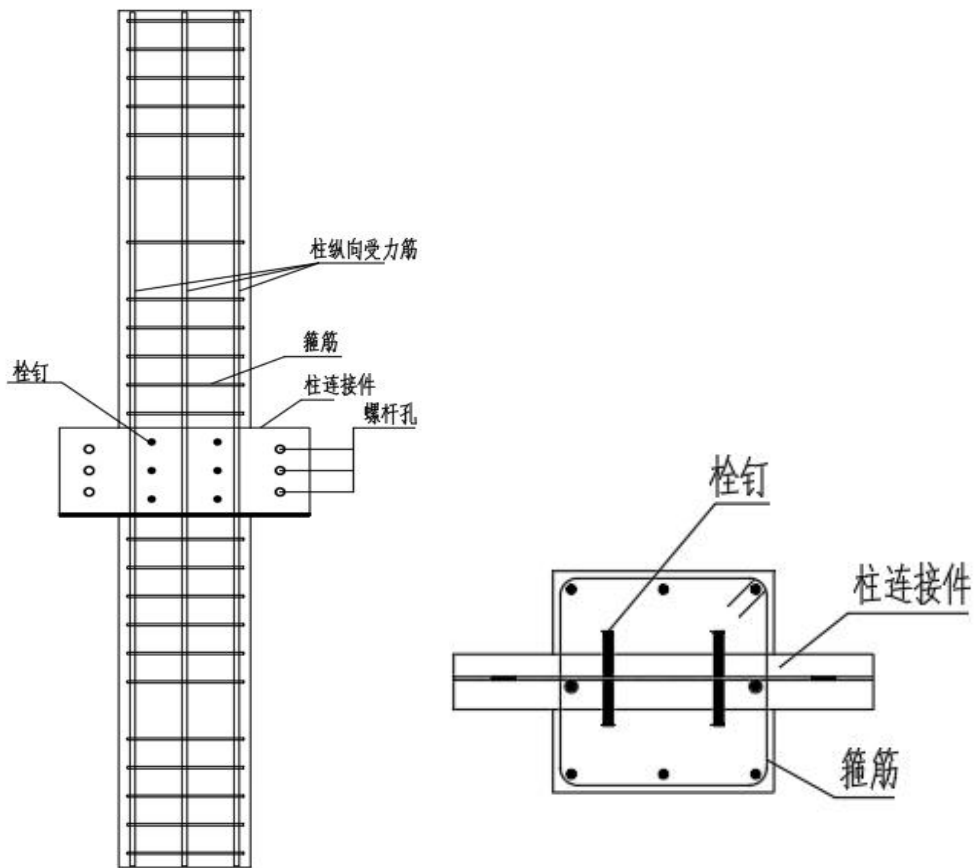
预制柱立面构造图 图 6.3.19-2 预制柱平面构造图
